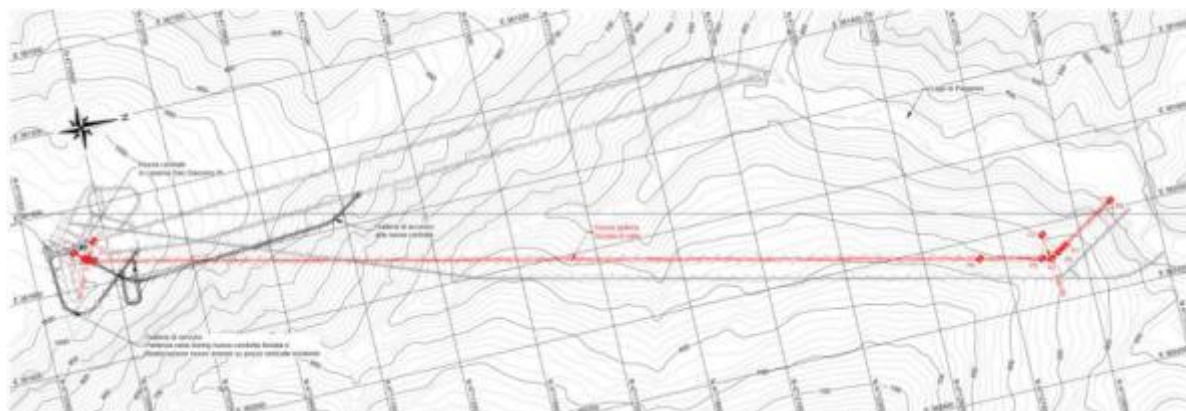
Nuova galleria forzata di scarico/aspirazione sulla derivazione Piaganini – pianta
